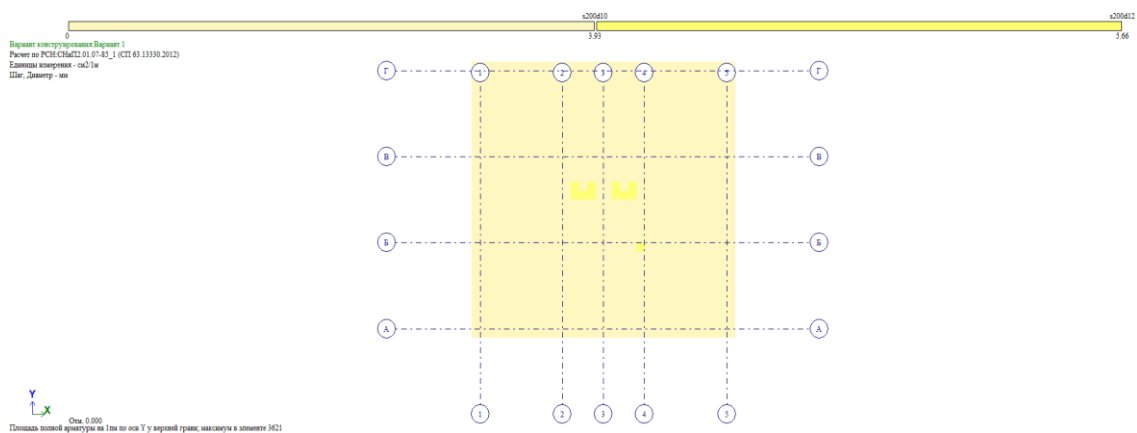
Требуемое армирование в верхней зоне плиты фундамента вдоль цифровых осей здания
